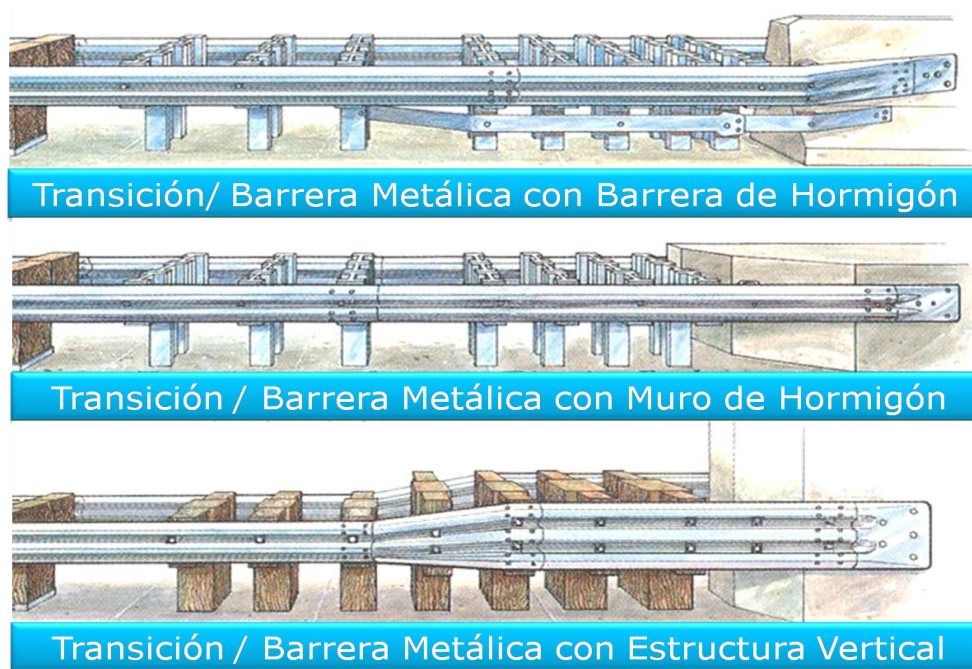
Diseño sección de transición entre una barrera flexible o semi rígida a un elemento rígido.
